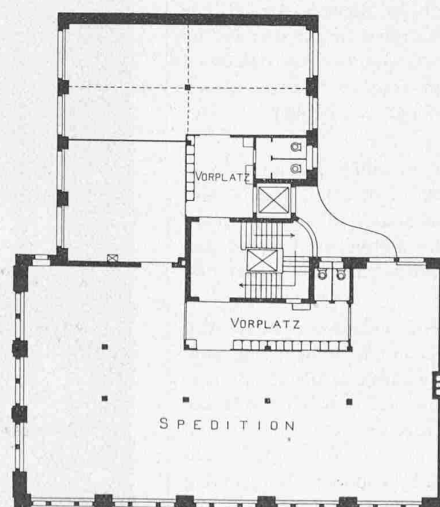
Grundriss vom vierten Obergeschoss.
